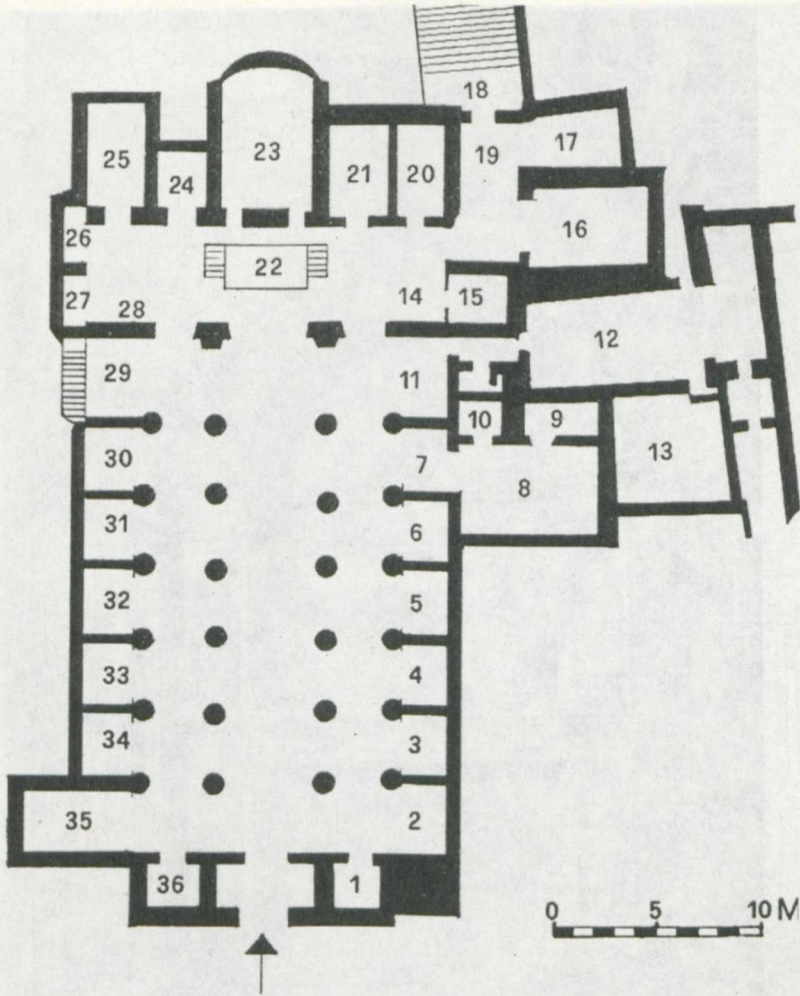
Neapel, San Domenico Kirche, Grundriß
